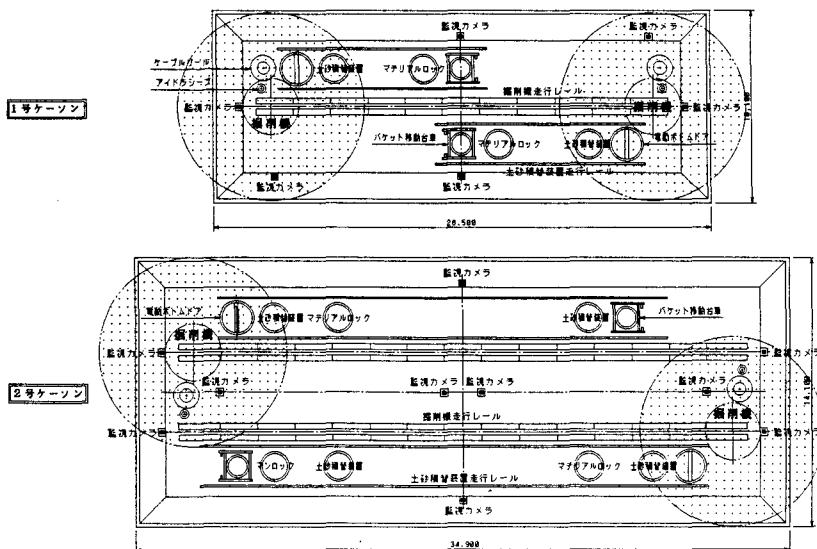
1号ケーソンおよび2号ケーソン函内設備配置図
